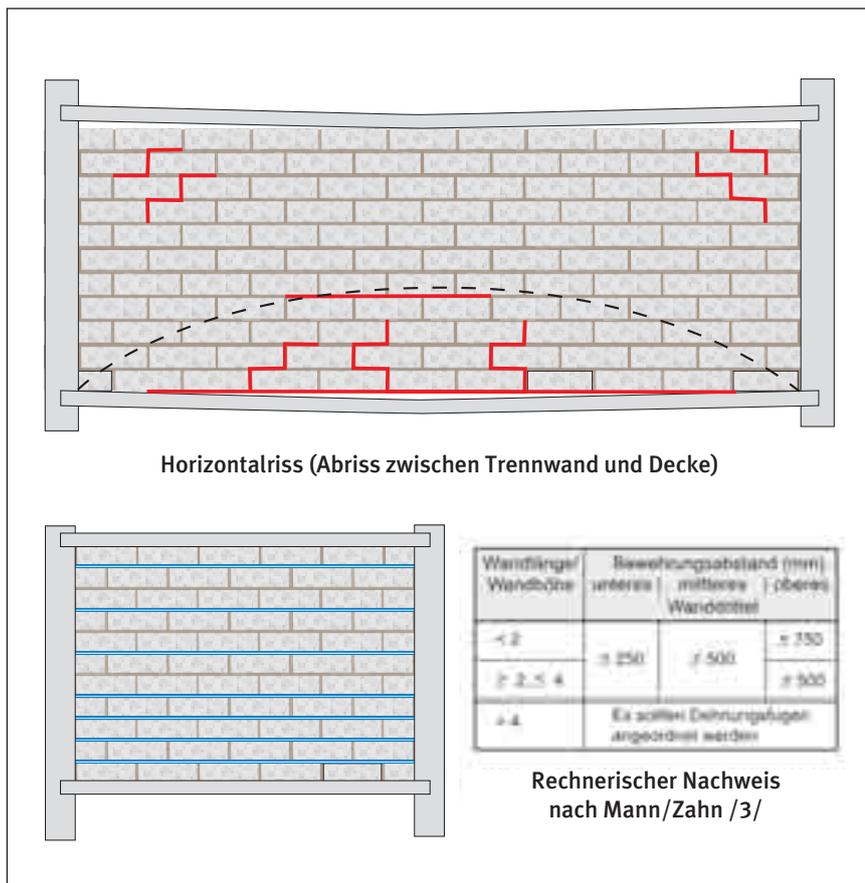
Konstruktive Lagerfugenbewehrung in nichttragenden inneren Trennwänden
